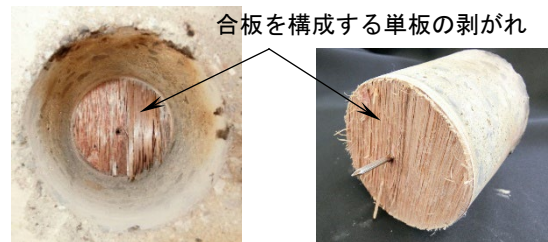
直接引張試験後に取り出した試験体の例示 (PAN-2)
